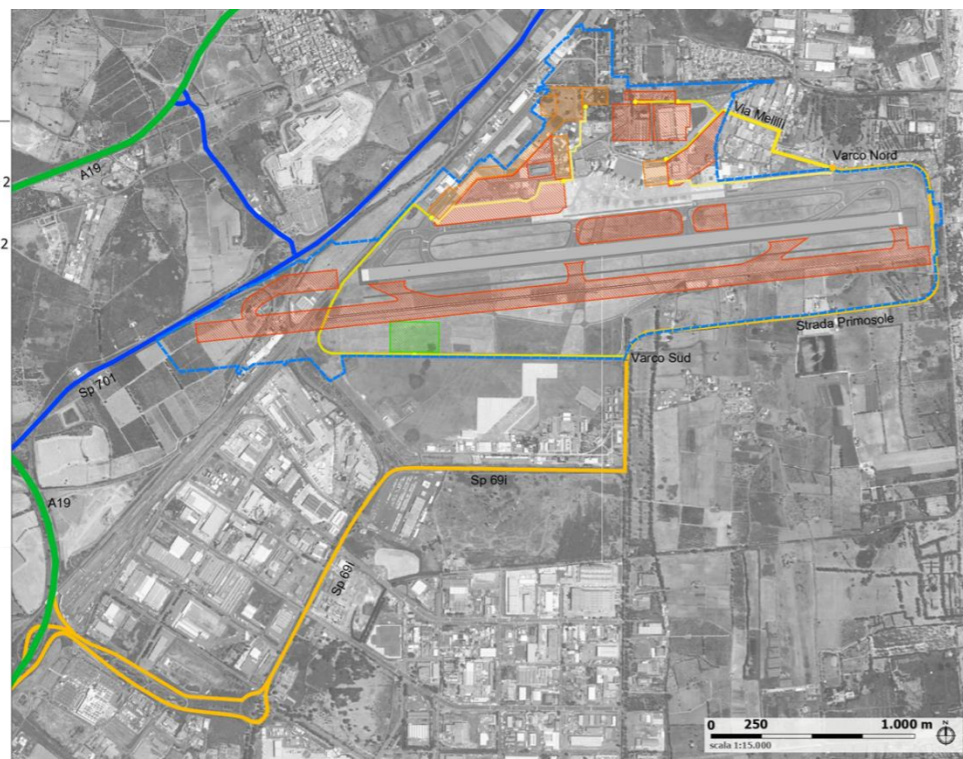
Layout complessivo del sistema della cantierizzazione
